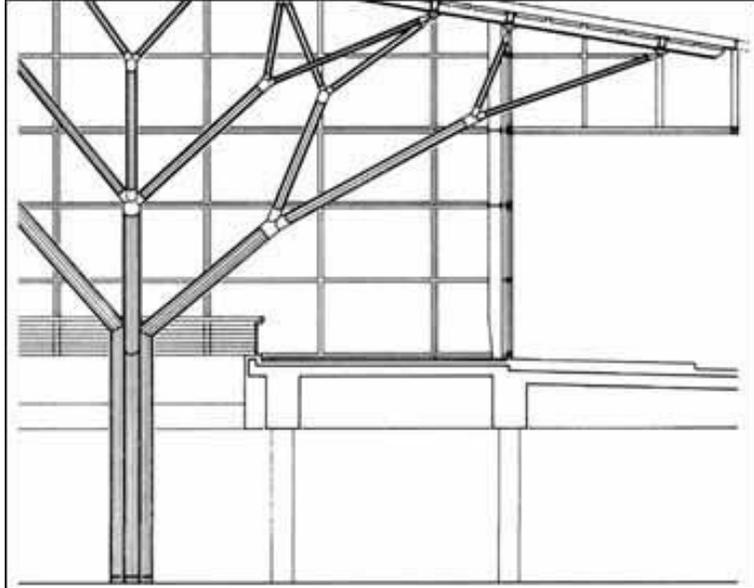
Estructura de acero del Aeropuerto de Stuttgart. Fuente: <http://www.strutture.info/images/ECCS/3-d1.jpg>
